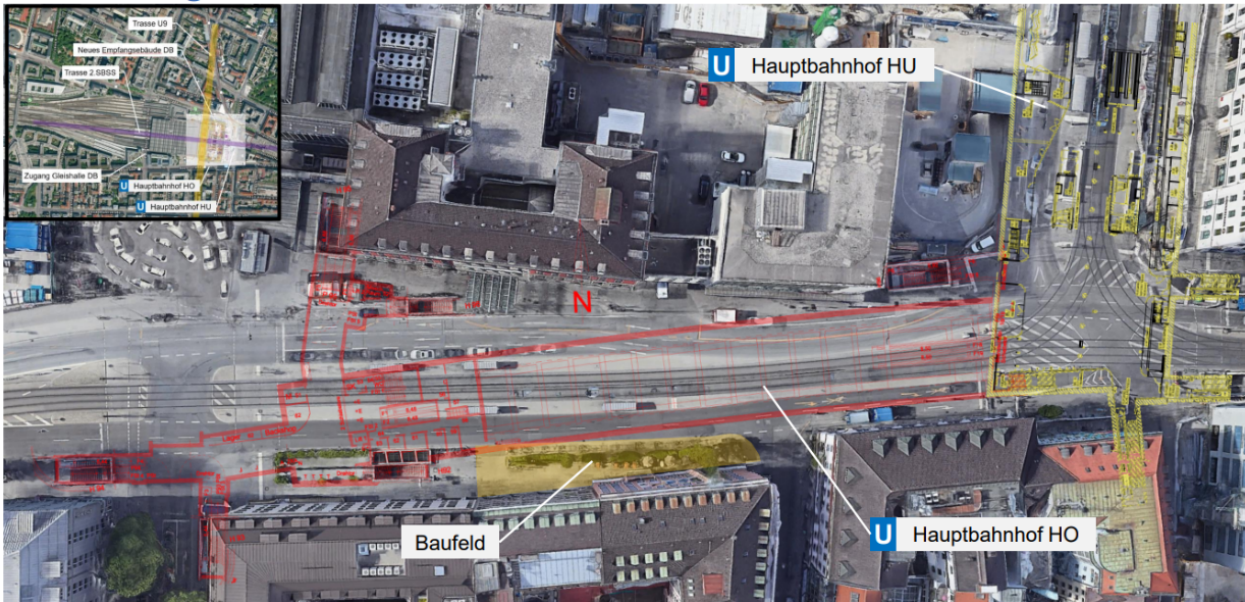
Lageplan U-Bahn-Station HO, Bayerstraße; Quelle: Google Earth
